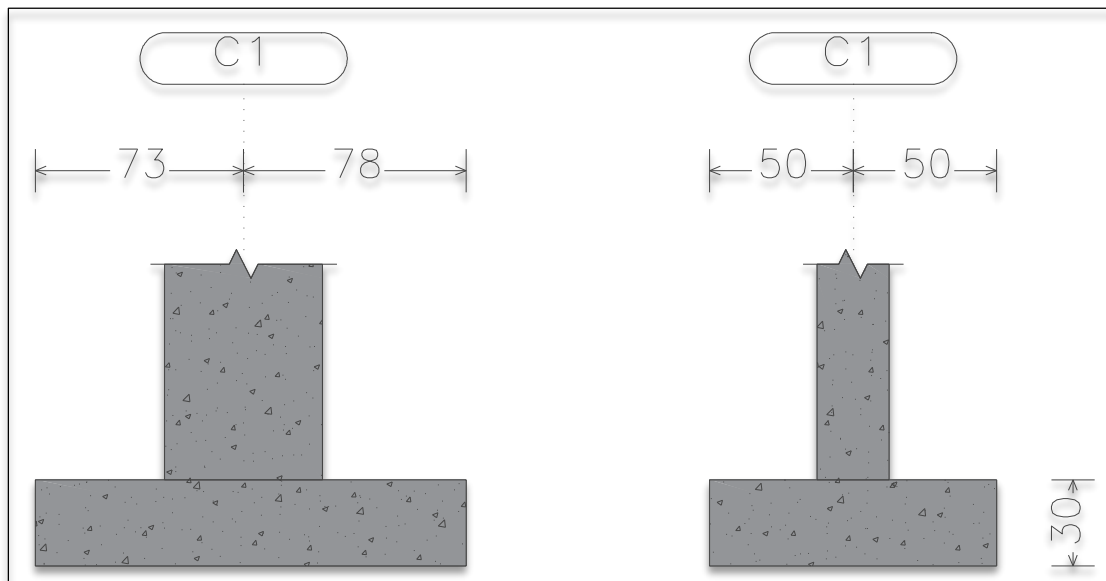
Dimensiones Zapata Centrada; Elaboración Propia
